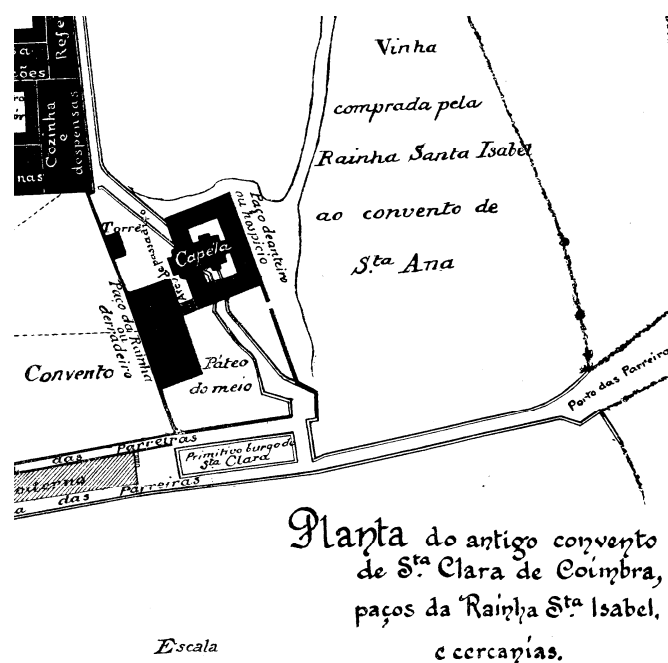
Pormenor da planta do convento de Santa Clara e dos paços da rainha D. Isabel, da autoria de António de Vasconcelos²⁴⁵.
